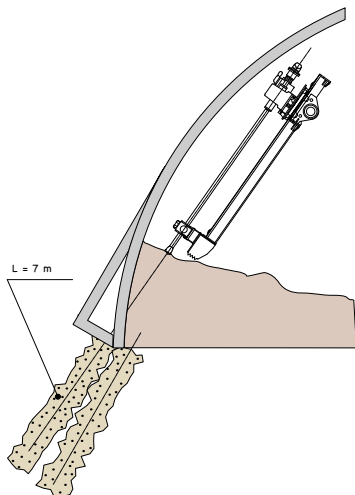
Sezione trasversale del tunnel mostrante lo schema d'intervento sui piedritti.
